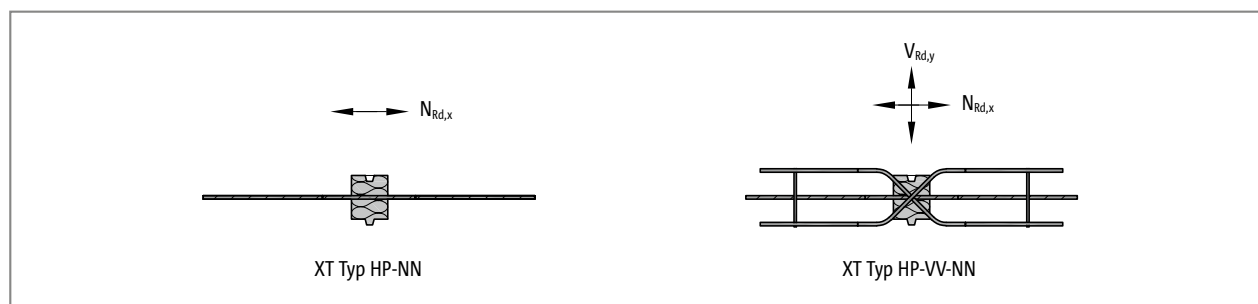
Schöck Isokorb® XT Typ HP: Typenauswahl
